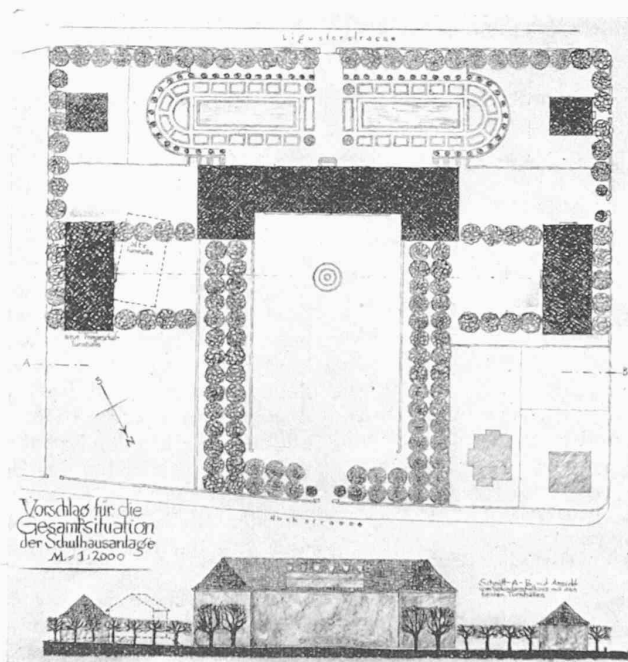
Lageplan und Schnitt. — Masstab 1:2000.
